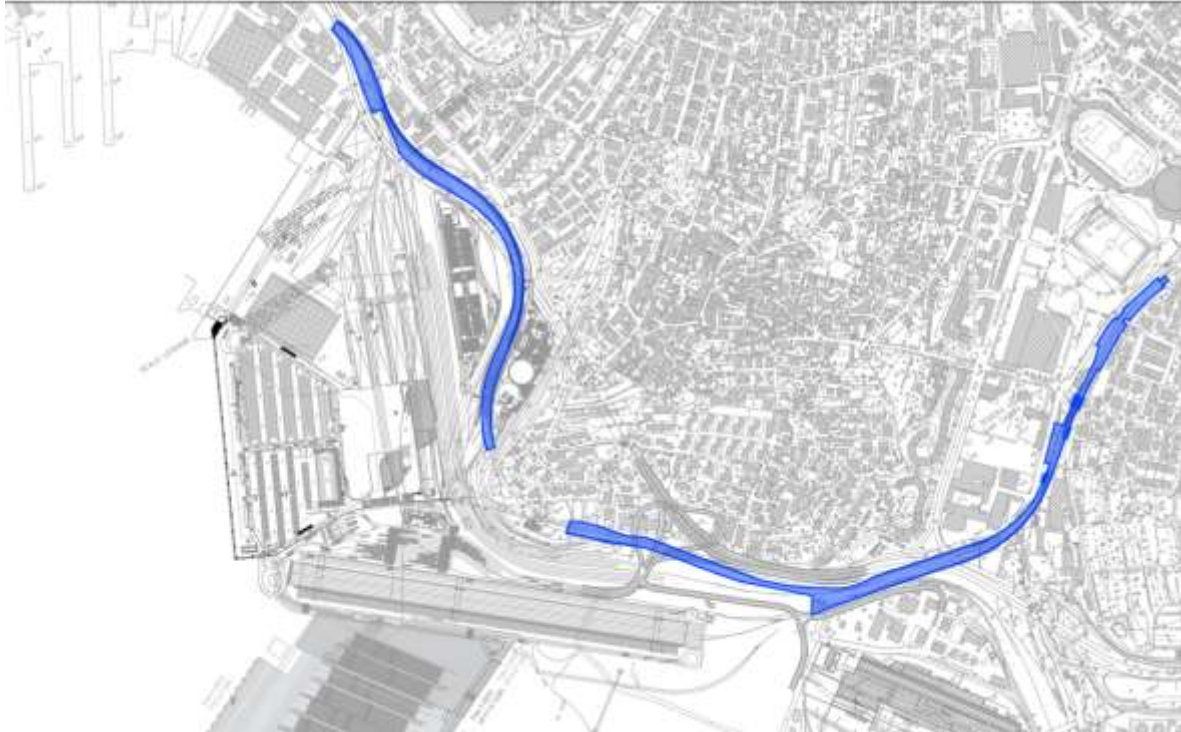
Planimetria delle opere ferroviarie Asset RFI
